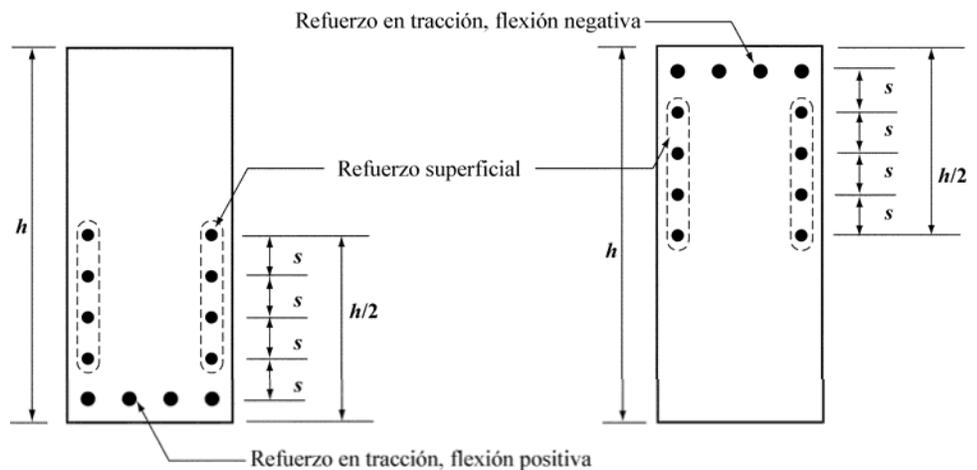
Refuerzo superficial para vigas y vigaletas con $h > 900$ mm
